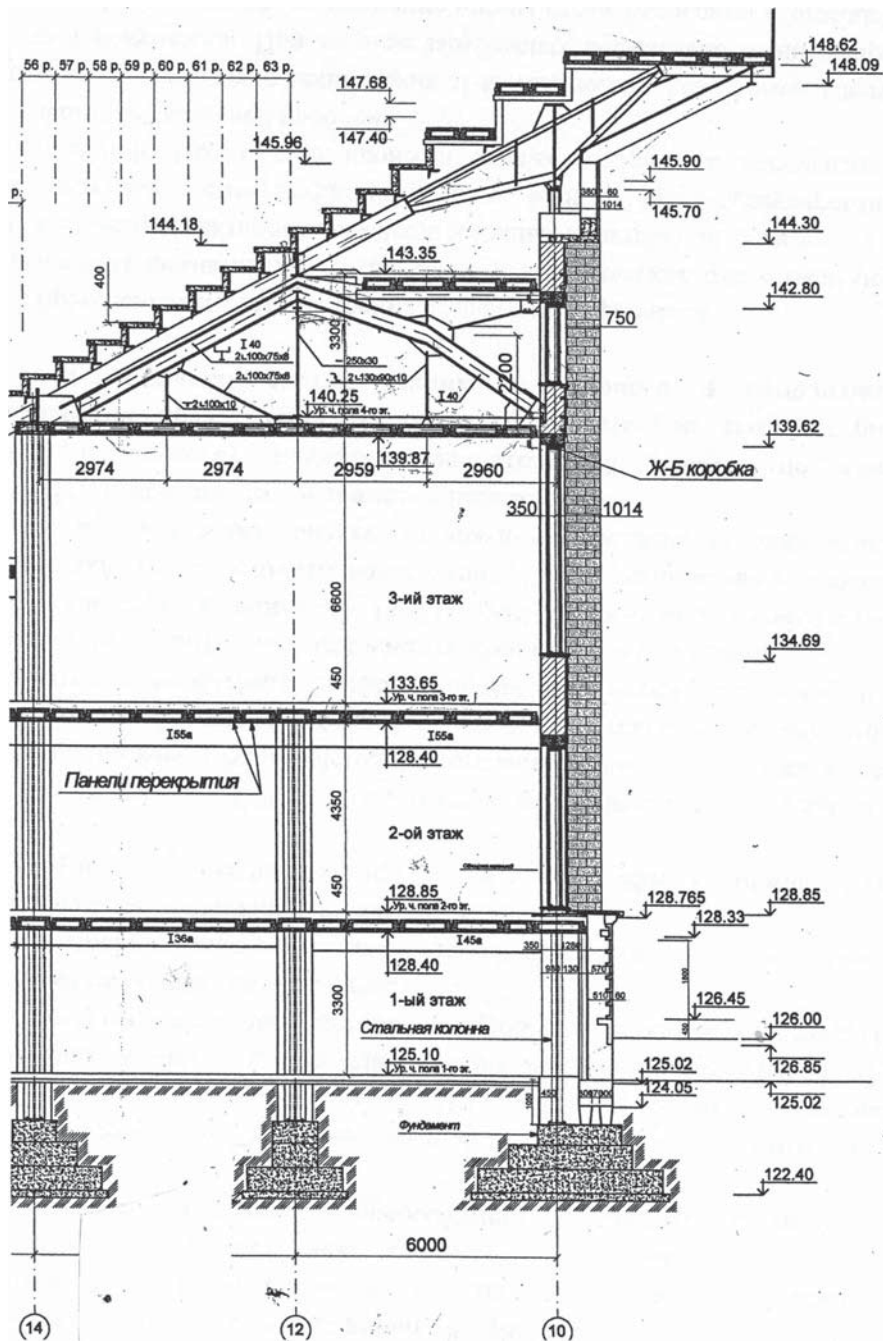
Разрез (подтрибунные помещения и фасадная стена). Фрагмент
